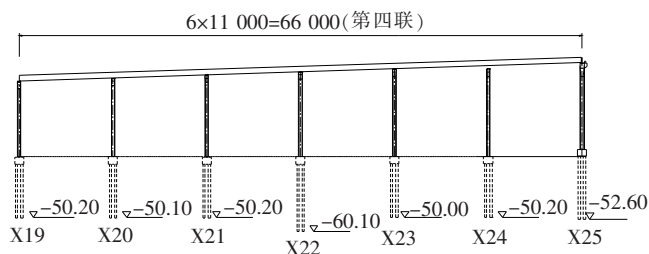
桥型布置图(除标高为 m 外,其余单位:cm)
